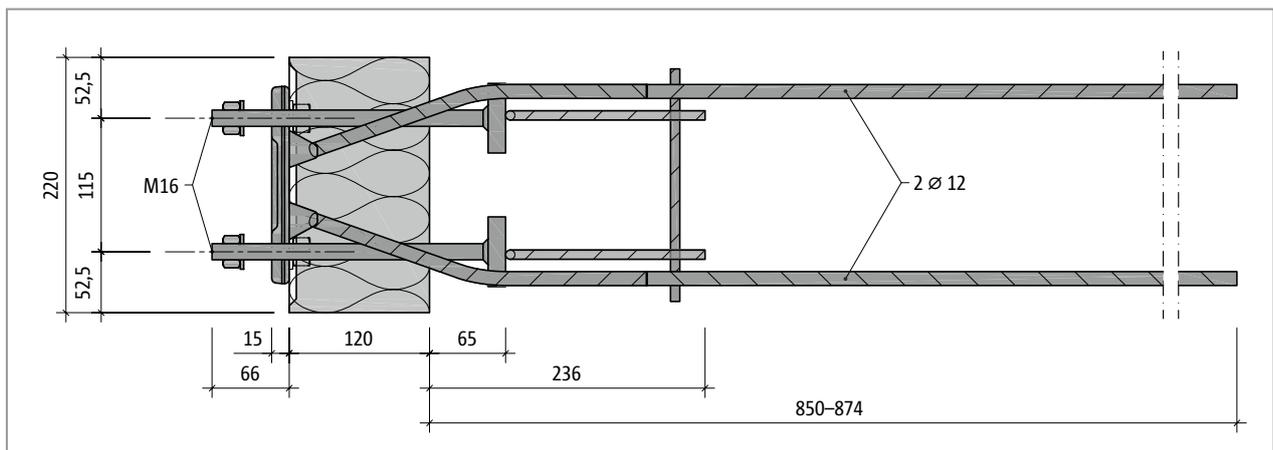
Schöck Isokorb® XT tipo SQ-V3: Plano
